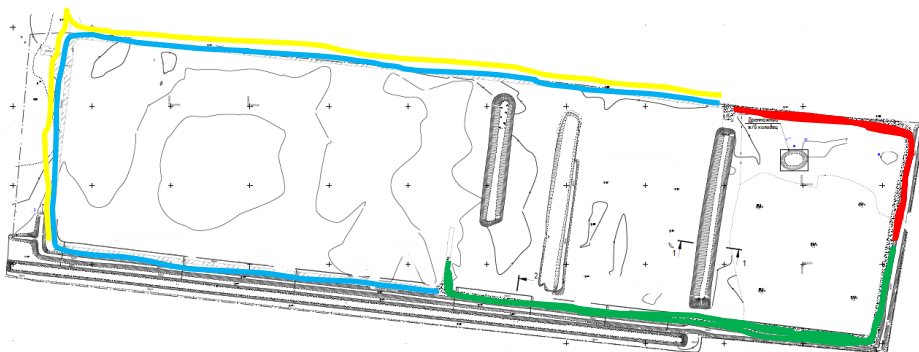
Схема расположения типов дорожного покрытия (Красный цвет – покрытие из щебня; Зеленый цвет – грунтовая дорога с включением щебня; Синий цвет – бетонная дорога; Желтый цвет – вдоль дороги из бетонных плит накатана грунтовая дорога)
